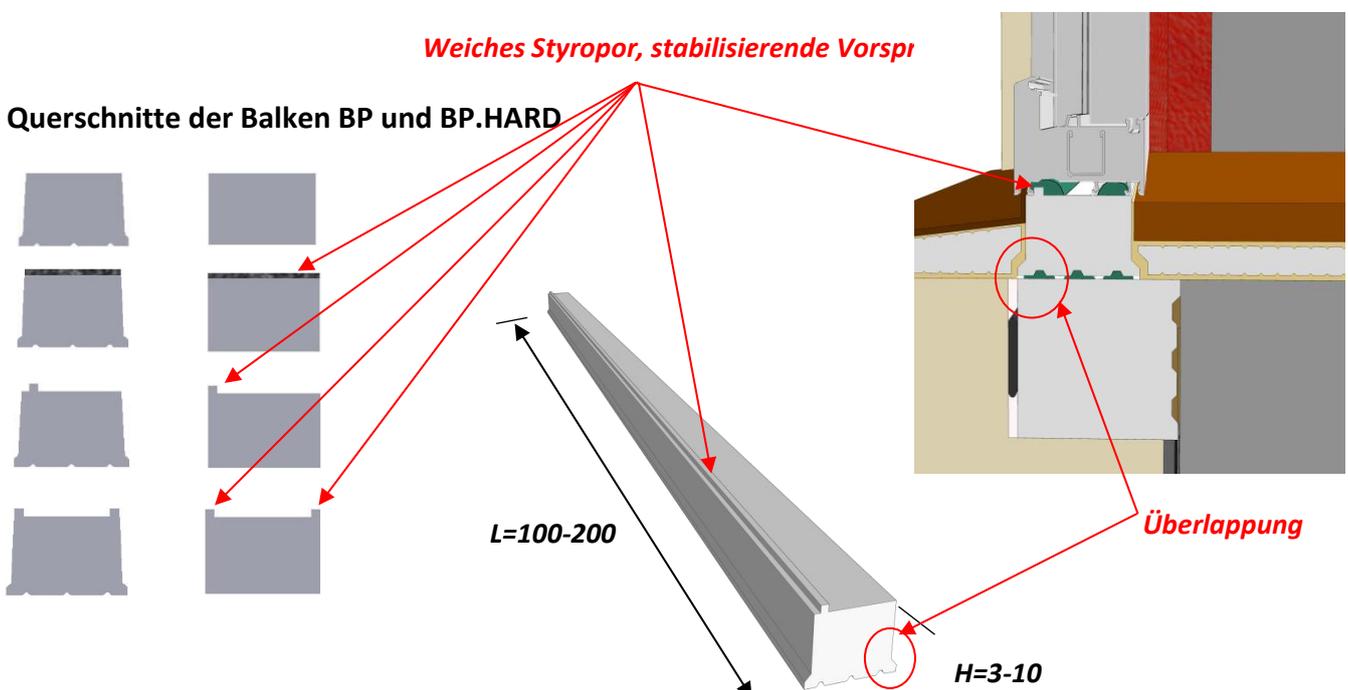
CBM-Ausführung – mit äußerer Stützkonsolle - Montage in der Fassadenebene
